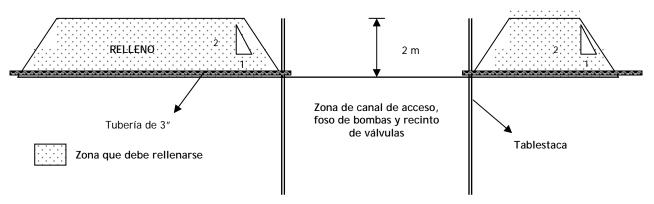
Detalle de las Zonas que deben Rellenarse - Corte 1-1- Perfil
